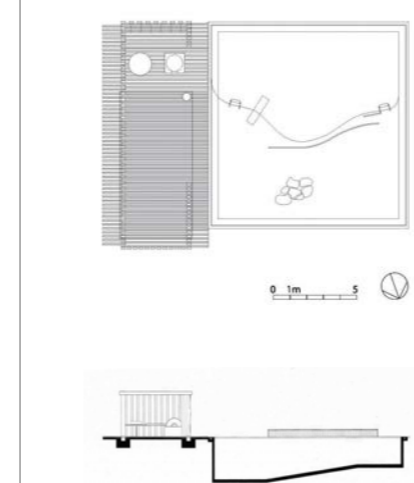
Planta y sección Quincha y Piscina, Rafael Iglesia
